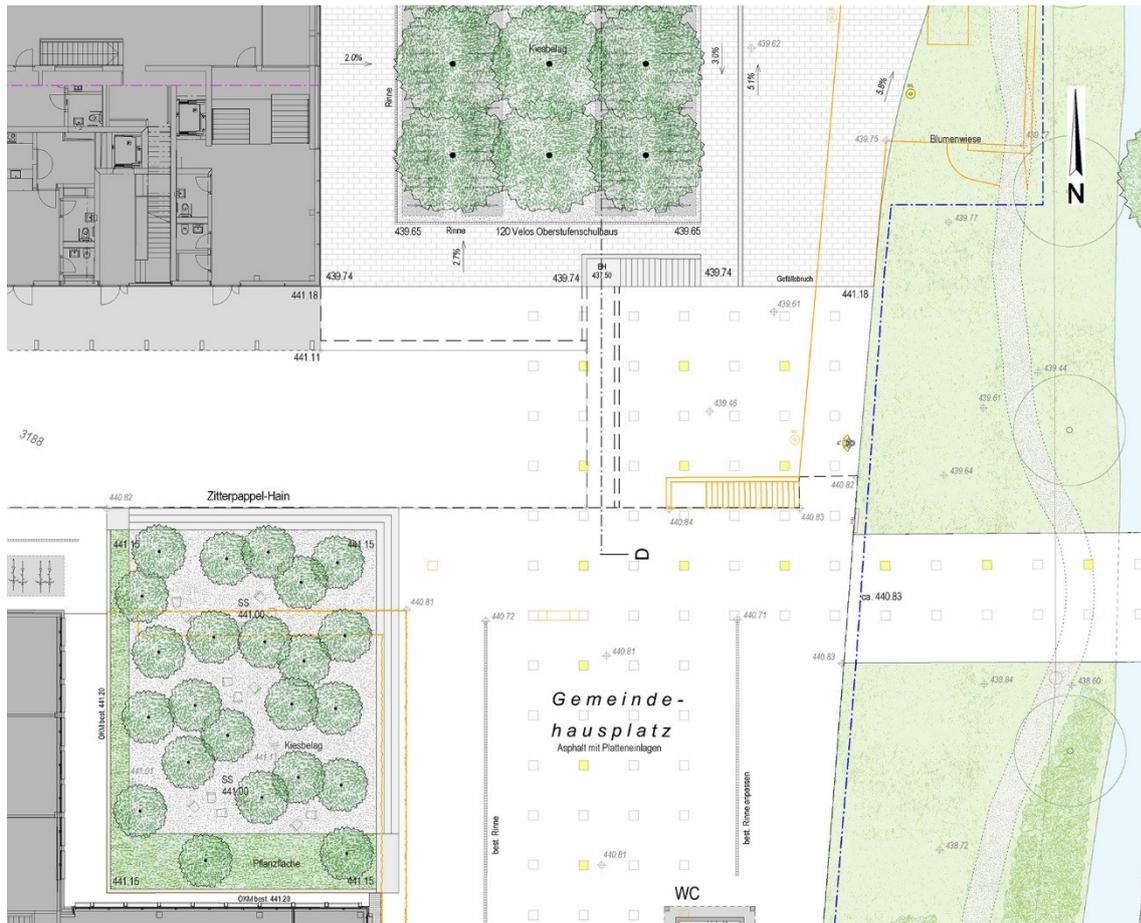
Situation Verbindung Gemeindefhausplatz-Schulhausplatz
